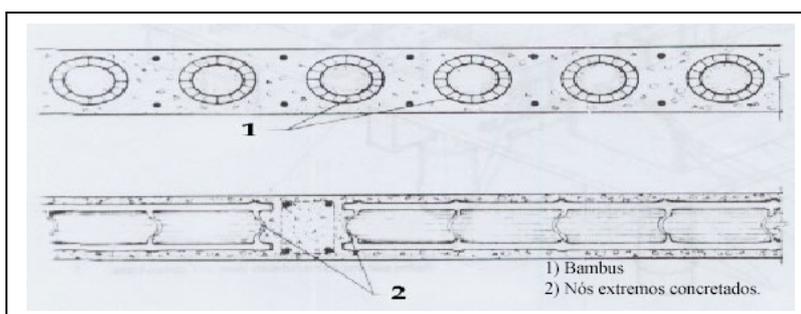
Corte esquemático da laje. (Fonte: Lopez, 1974 apud Oliveira, 1980).
